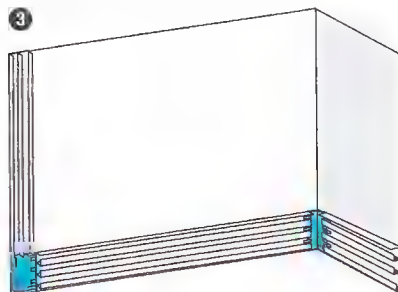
Короба с дополнительными элементами (аксессуарами)
